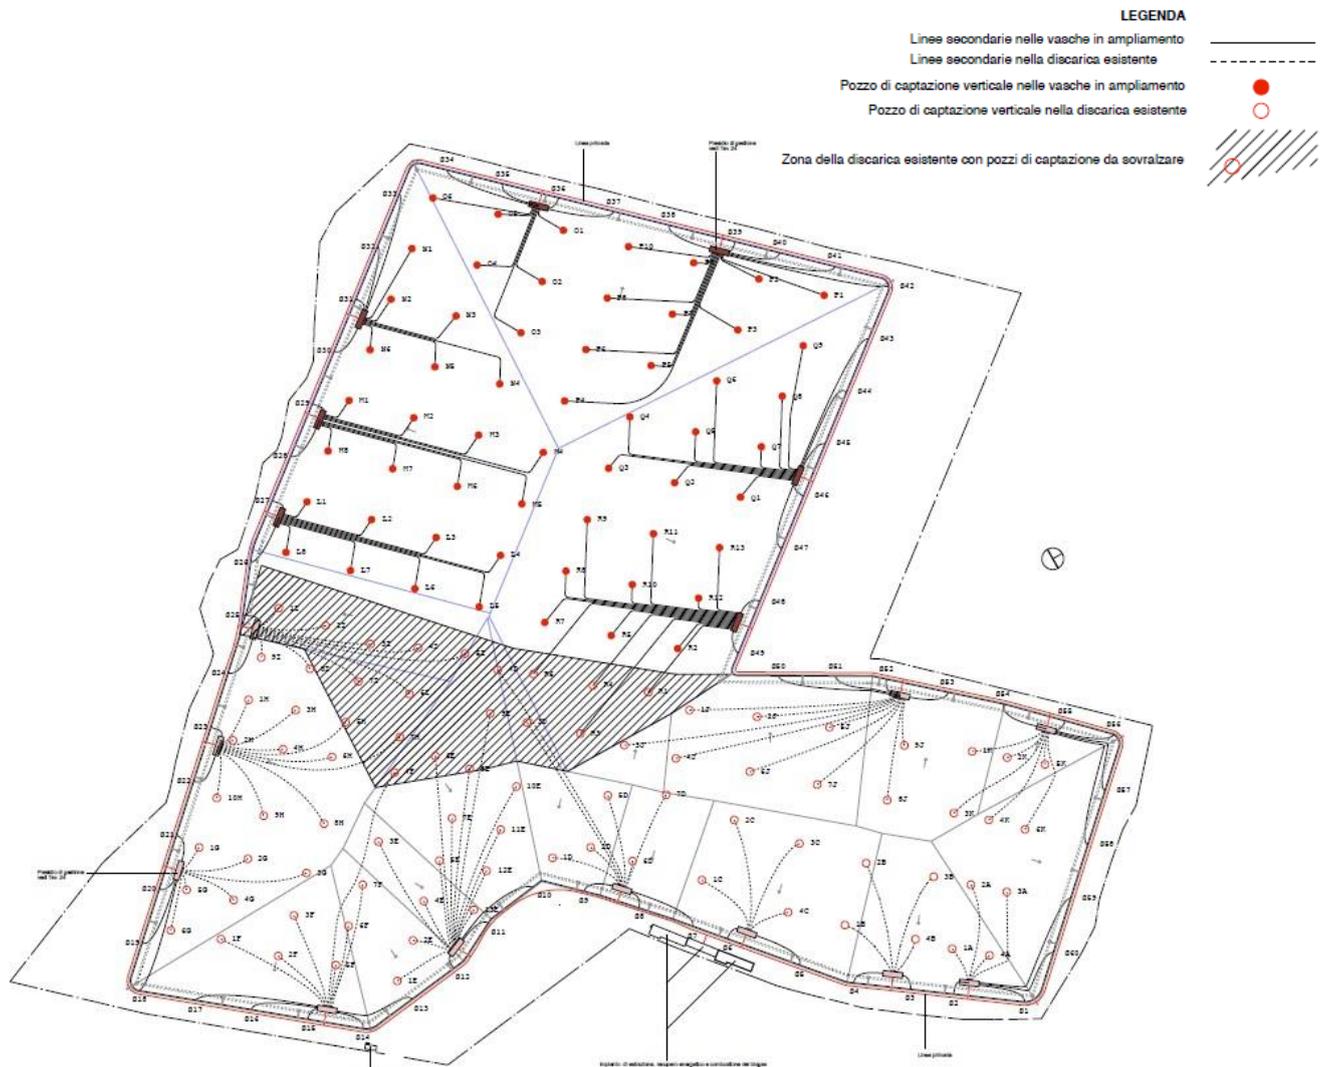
Planimetria generale di progetto - sistema di captazione del biogas
